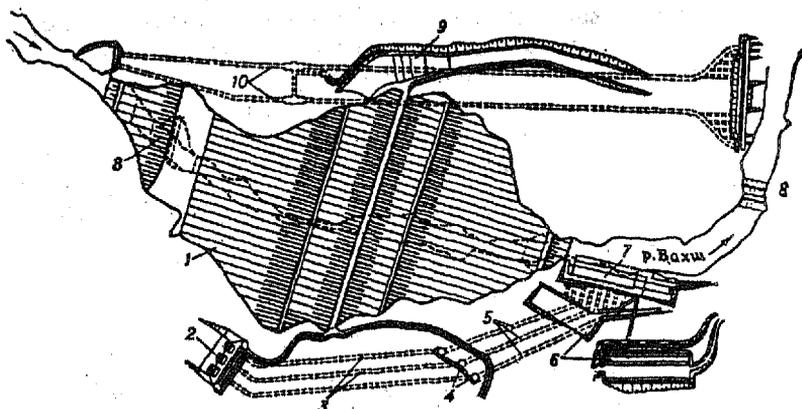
Схема гидроузла Нурекской ГЭС на р. Вахш: 1 - плотина; 2 - водоприемник ГЭС; 3 - напорные водоподводящие туннели; 4 - уравнильные резервуары; 5 - турбинные водоводы; 6 - открытое распределительное устройство; 7 - здание ГЭС; 8 - верховая и низовая перемильчики; 9 - открытый водосброс с отводящим каналом; 10 - строительные туннели
